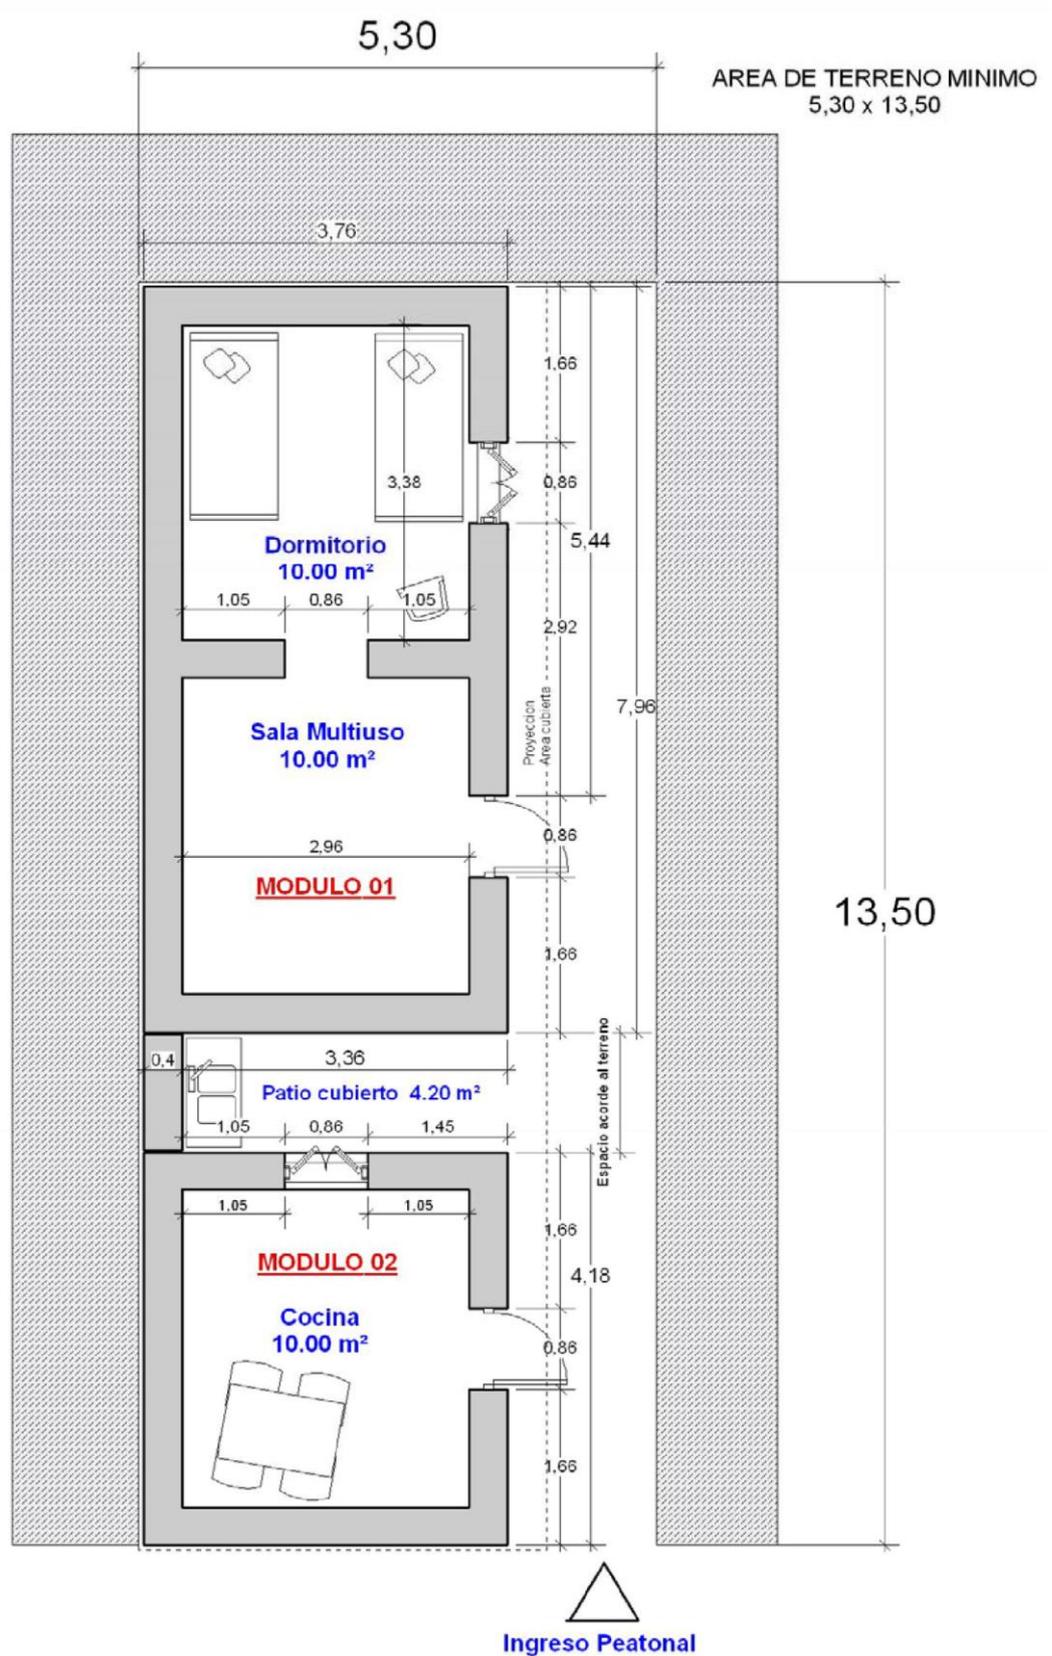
Planta del modelo de vivienda. Elaboración propia.
